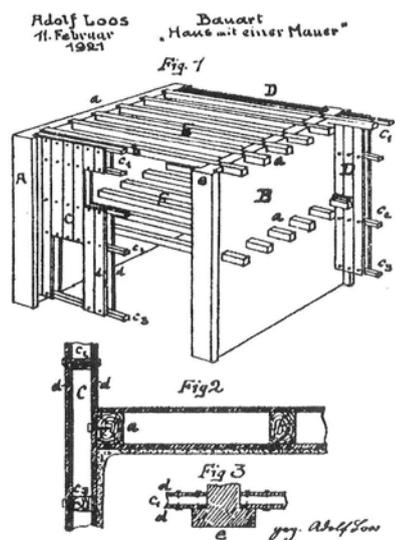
Bauskizze des Hauses an einer Wand (r)
